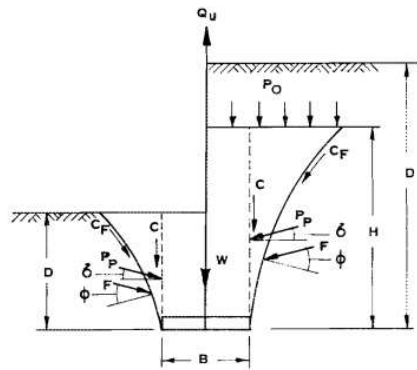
Cálculo de pilotes a tracción (Meyerhof y Adams 1968).
